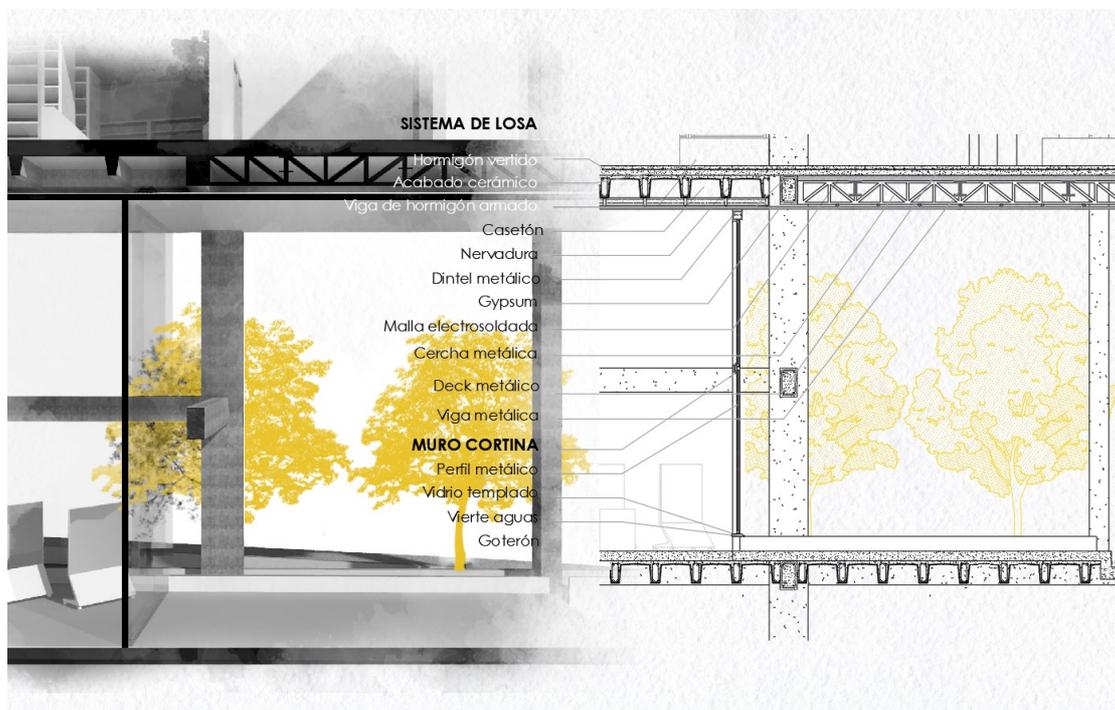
, Detalle constructivo Ingreso. Elaboración propia
